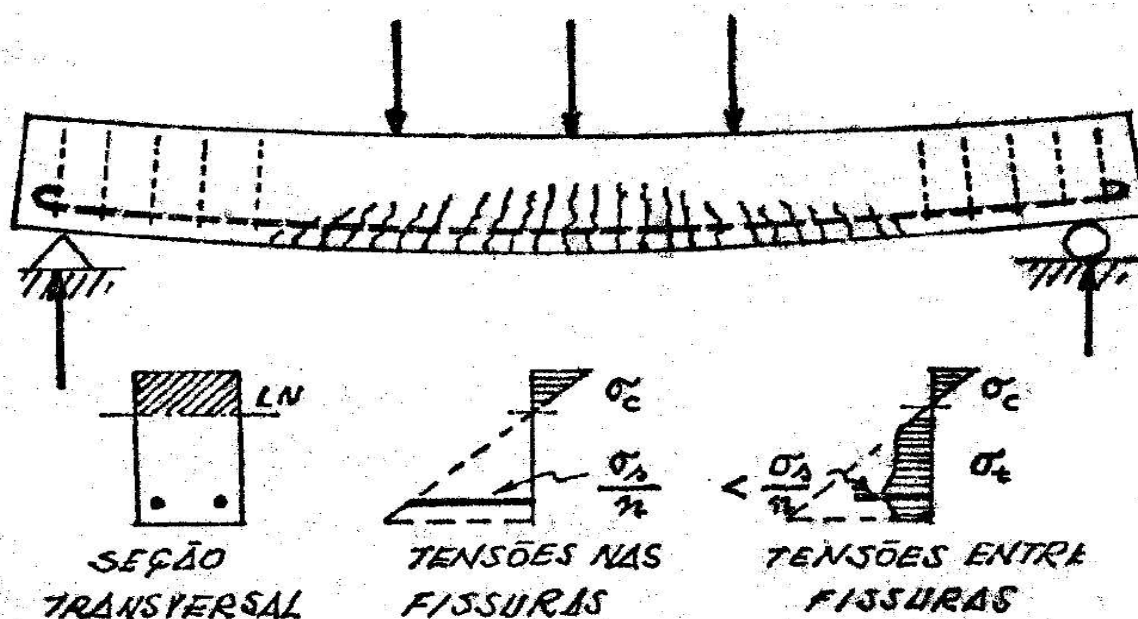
Fissura em Vigas de Concreto Armado
